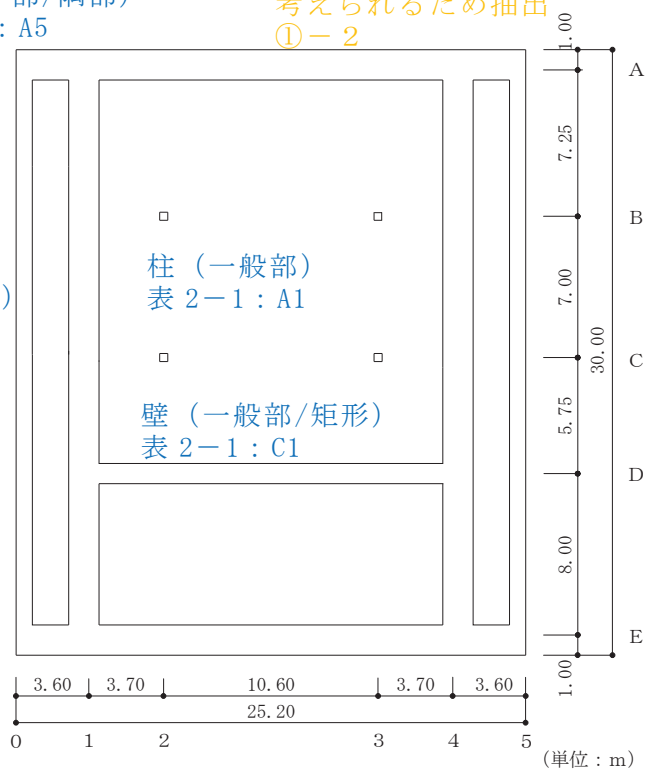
(1) 緊急用電気品建屋の概略平面図 (0.P. \* 56.4m)
